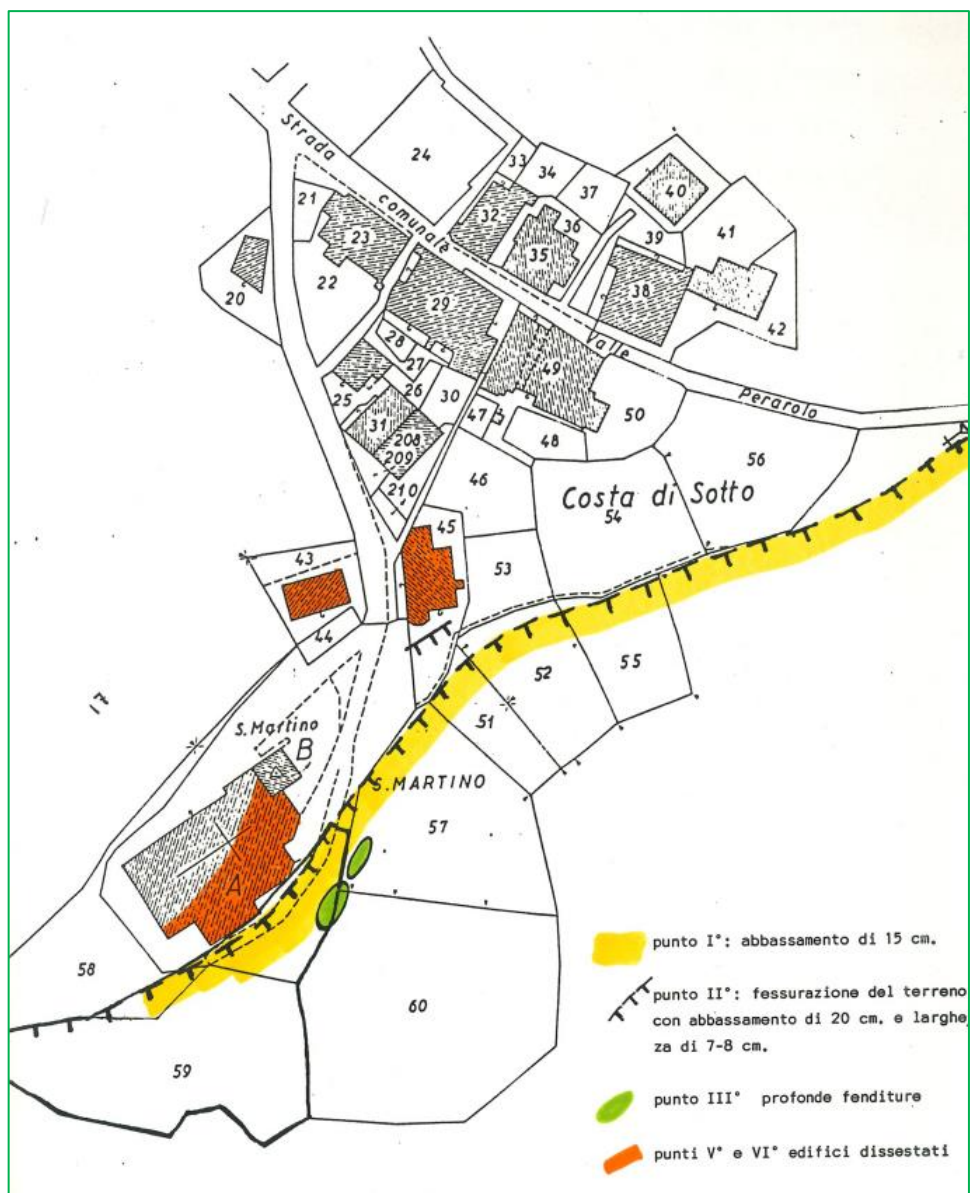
Planimetria dei dissesti 1967 estratto dall'allegato [1]
